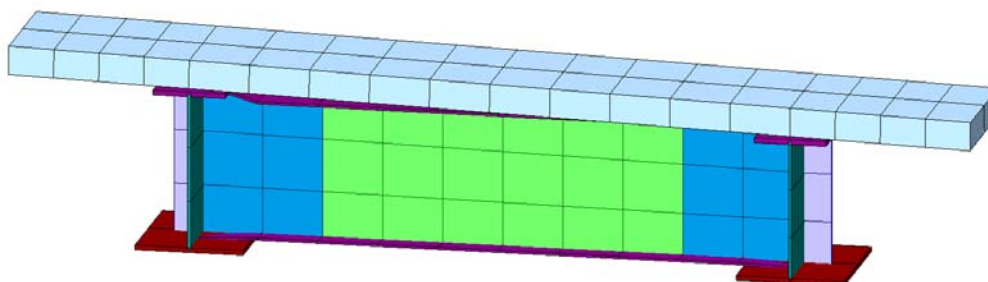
Sovrappasso di ingresso - diaframma pieno di pila
